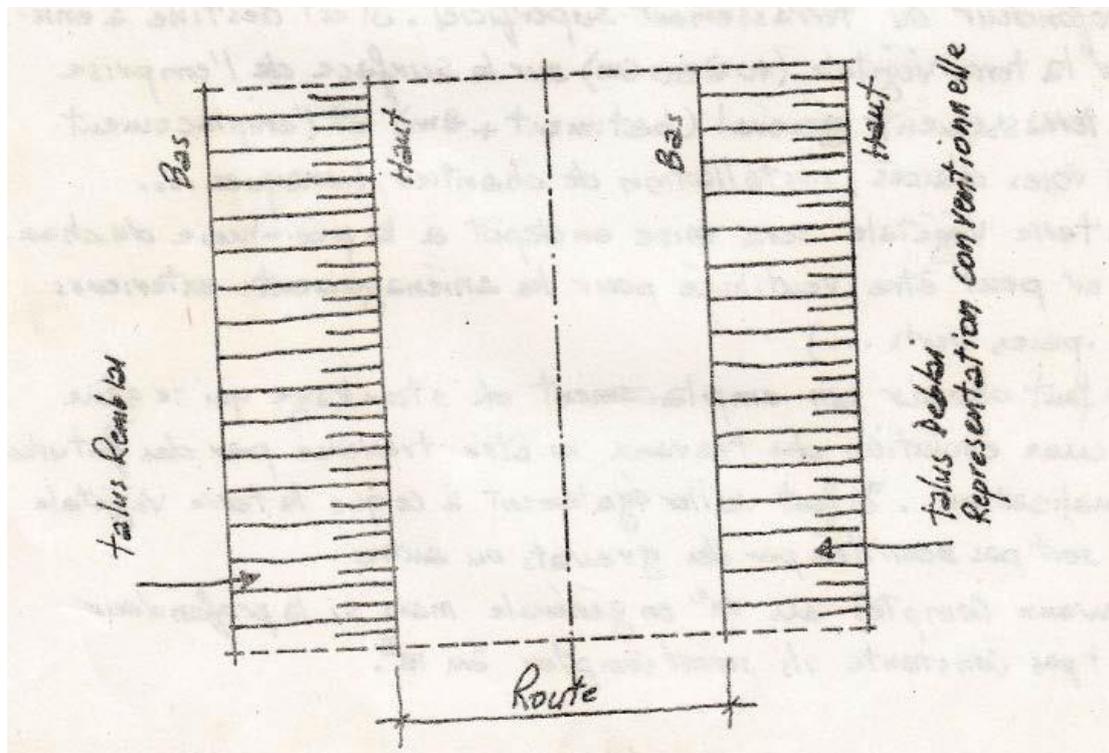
Schéma remblais et déblais en plan (vue en plan de figure 1)
